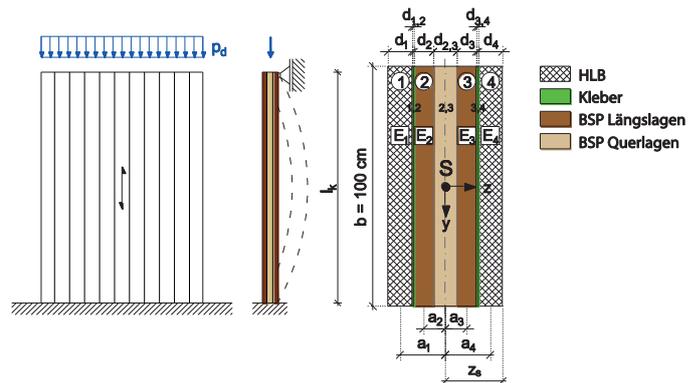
HLB-Brettsperrholz-Wandverbundkonstruktion
